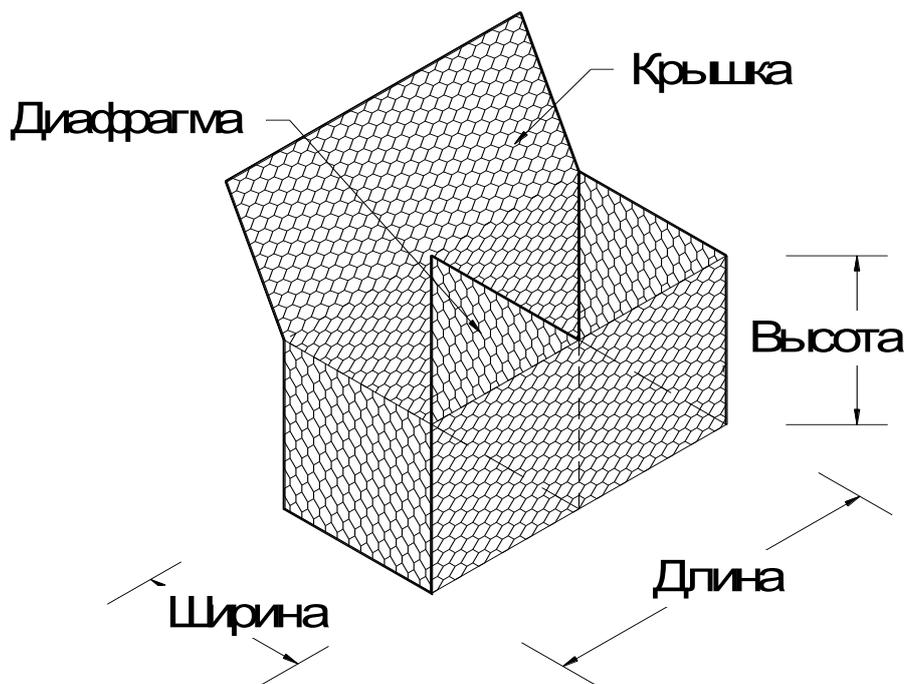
Конструктивная схема габионных конструкций коробчатых (габионов)
